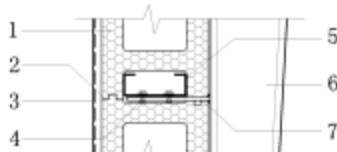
墙体水平芯肋与结构柱连接组合构造示意
